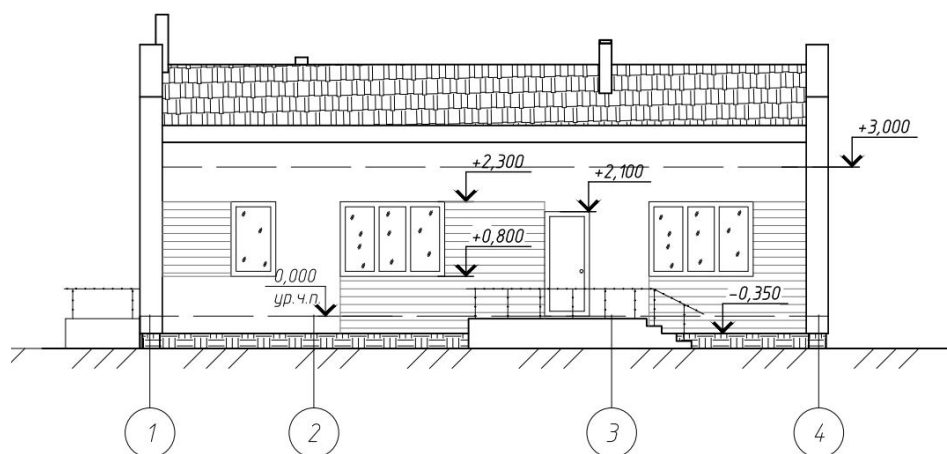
Фасад индивидуального одноэтажного жилого дома площадью 113 м²
